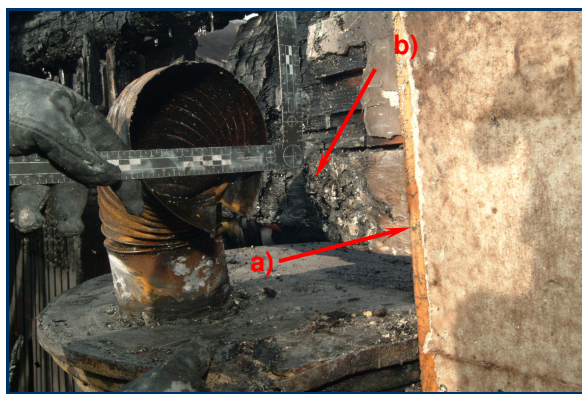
Détail de l'installation de chauffage : a) pourtour fibrociment - bois - brique ; b) surface supérieure : bois - brique
